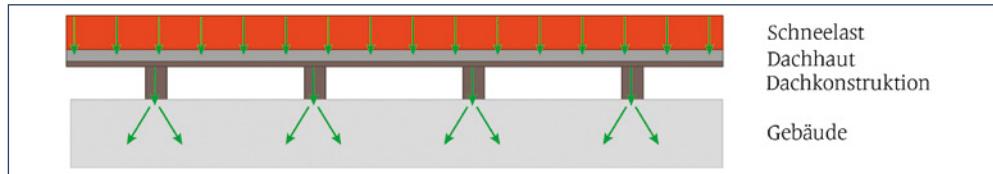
Schema Lastabtragung eines Sparrendaches mit gleichmäßiger Sparrenbelastung
